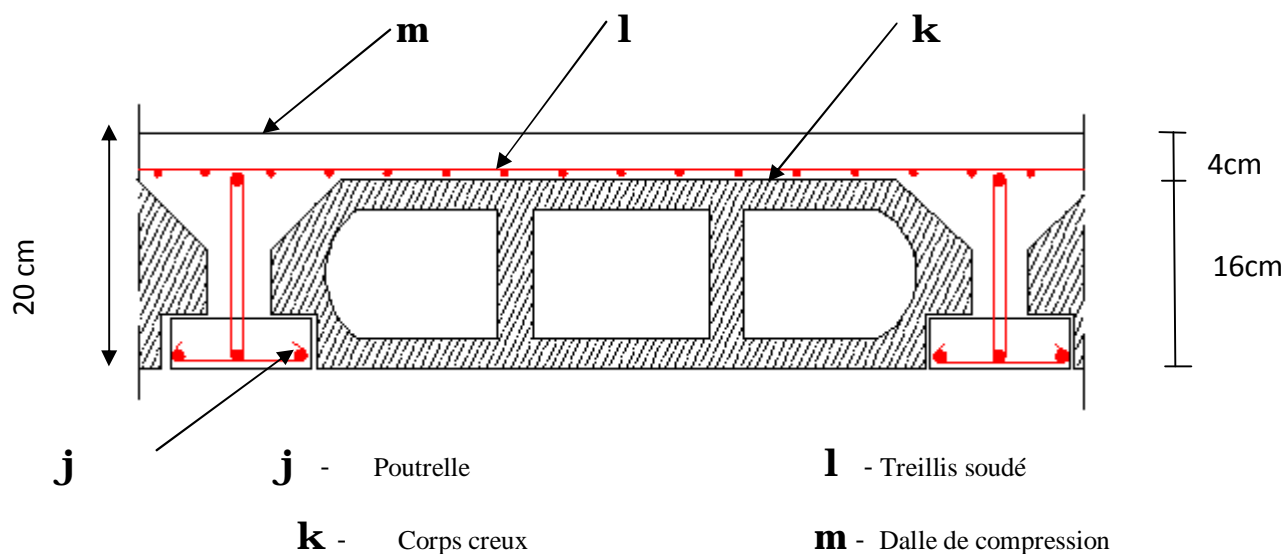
Schéma descriptif d'un plancher en corps creux.
